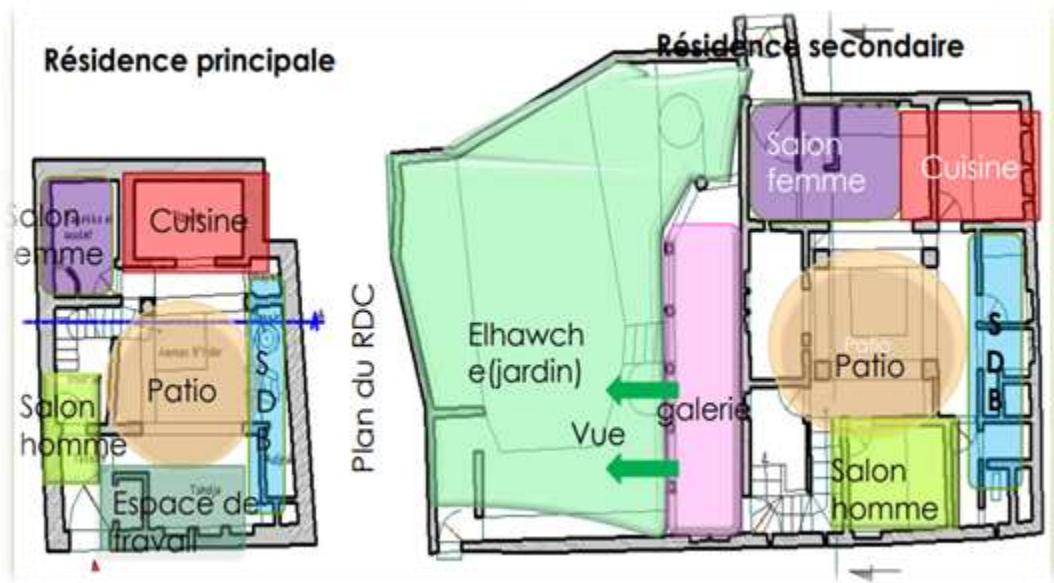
Analyse d'un plan d'une maison traditionnelle par André ravereau
